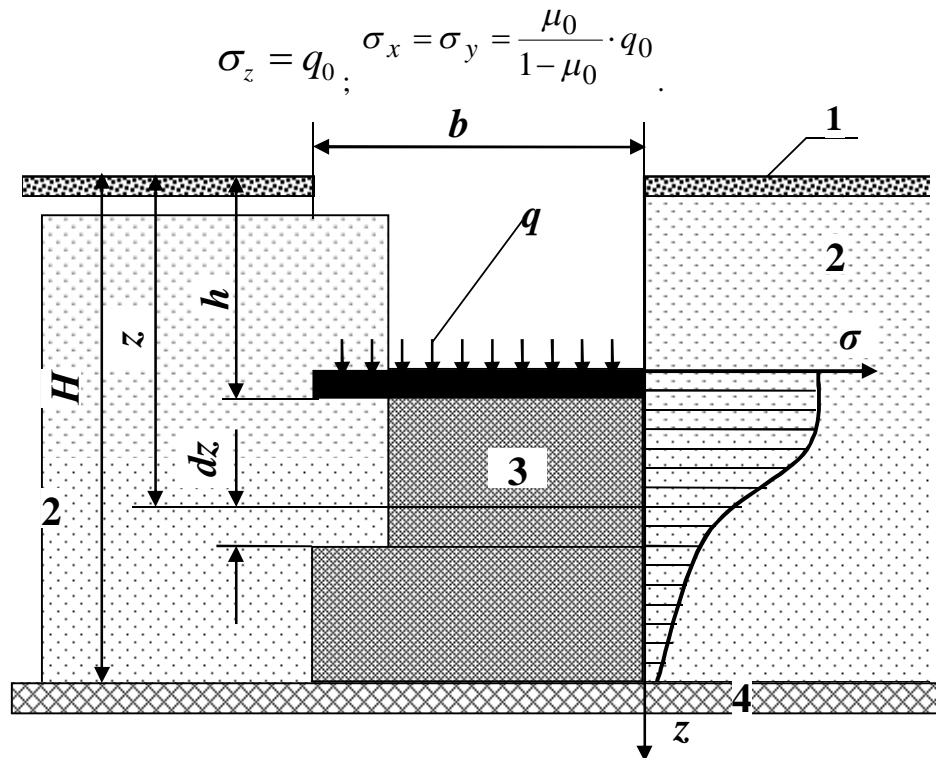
Расчетная схема для определения уплотнения слабого грунта: 1 – поверхность грунта, 2 – неуплотненный грунт, 3 – уплотненный грунт 4 – твердый слой грунта
